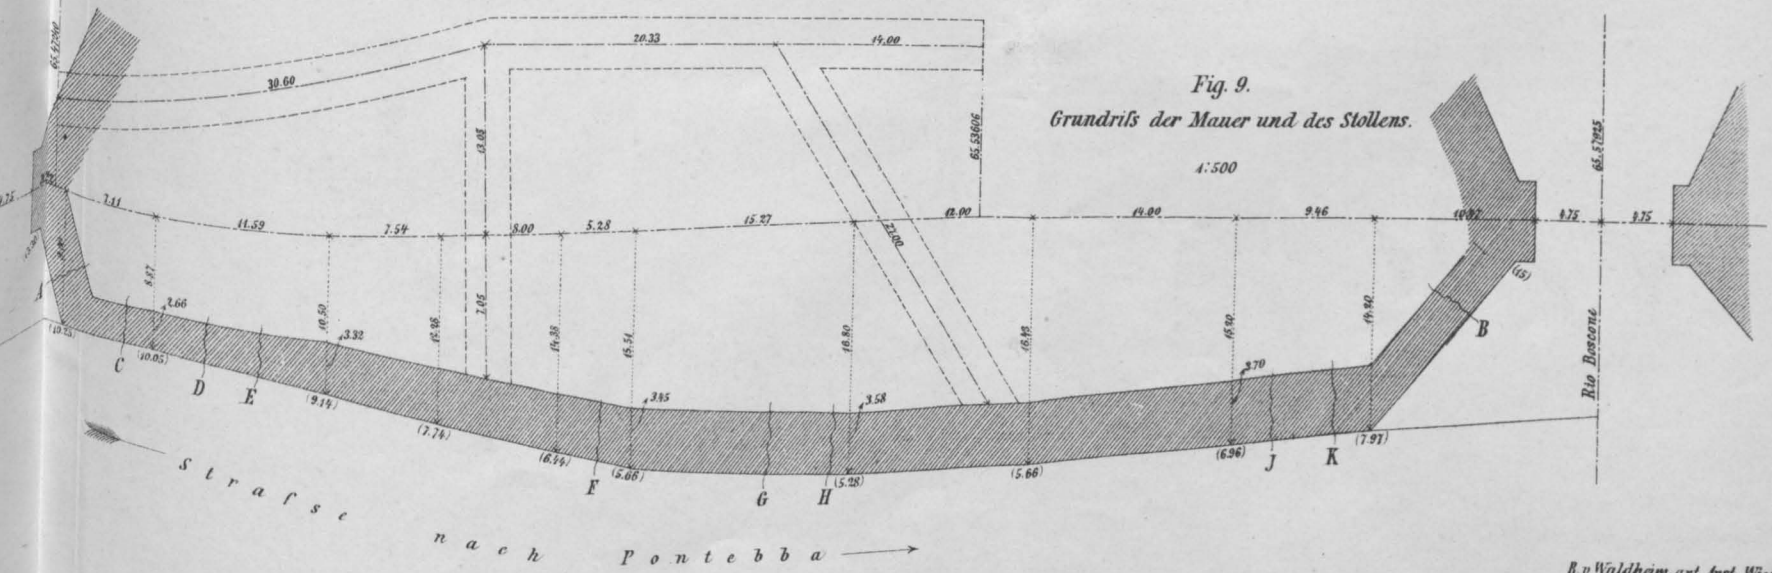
Grundriss der Maer und des Stollens.
